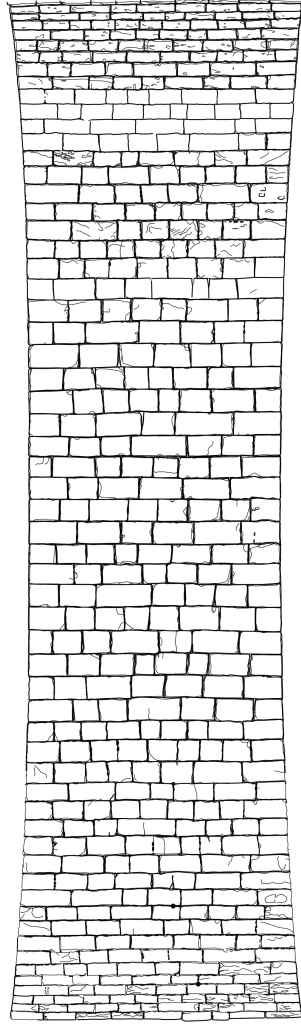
桥脚部 (ア一チ下部) 石垣立面图 (S=1/150)
